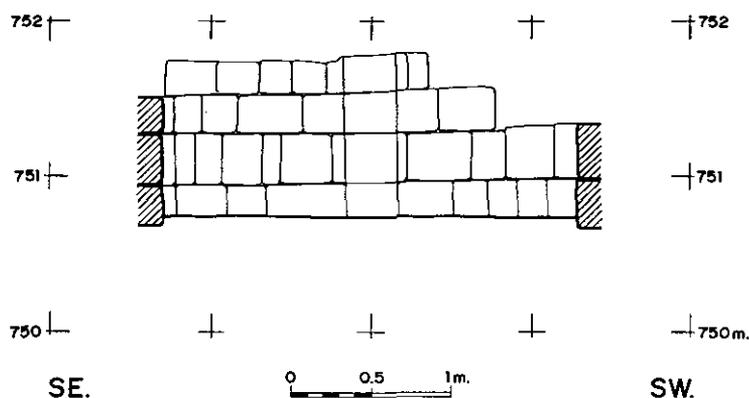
Estanque Monumental: detalle del alzado del extremo Sur.
